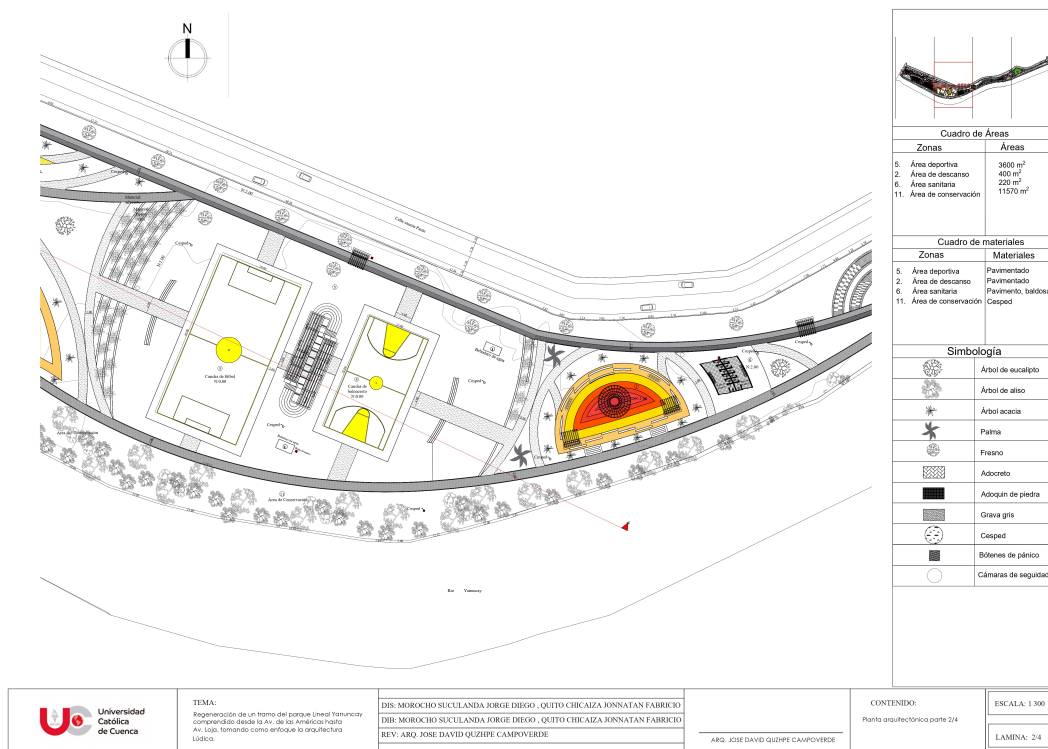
Planta 2 de 4. Fuente : Propia
